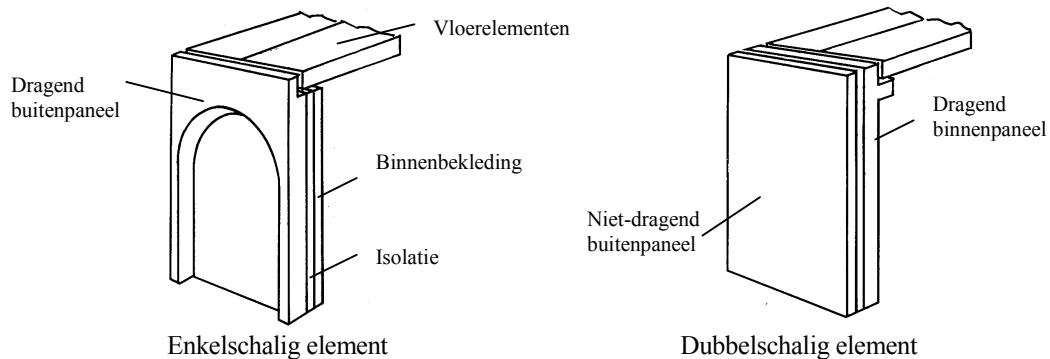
Principetekeningen van dragende gevels in architectonisch beton
